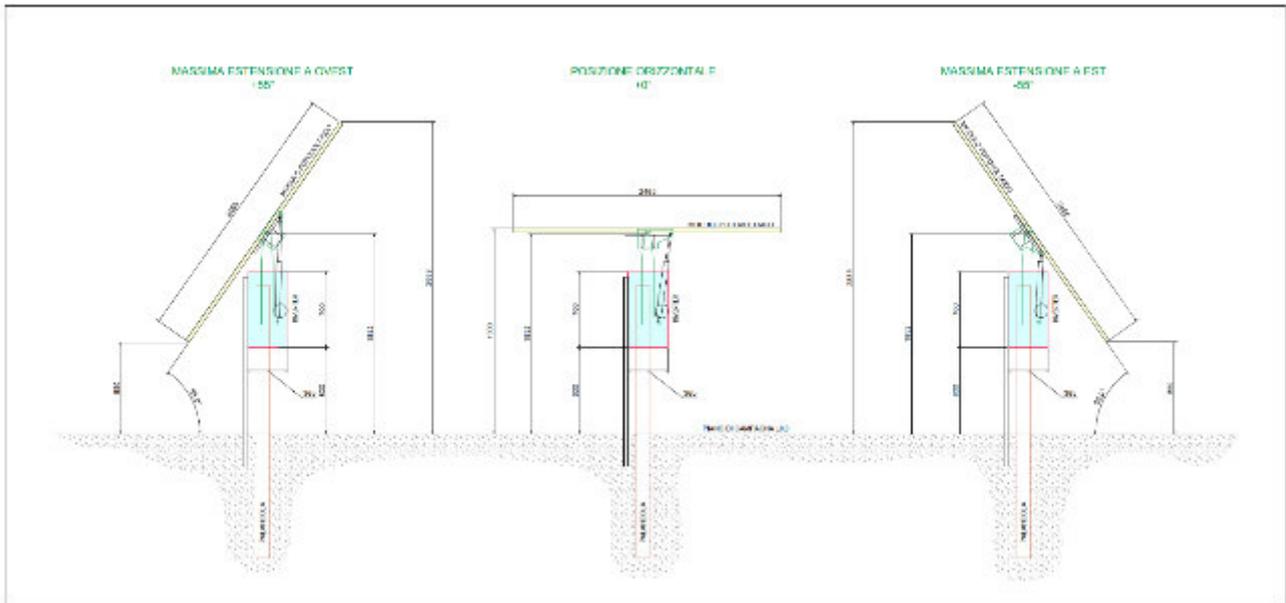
Estensione del pannello in movimento (Fonte: Relazione tecnica elettrica)
